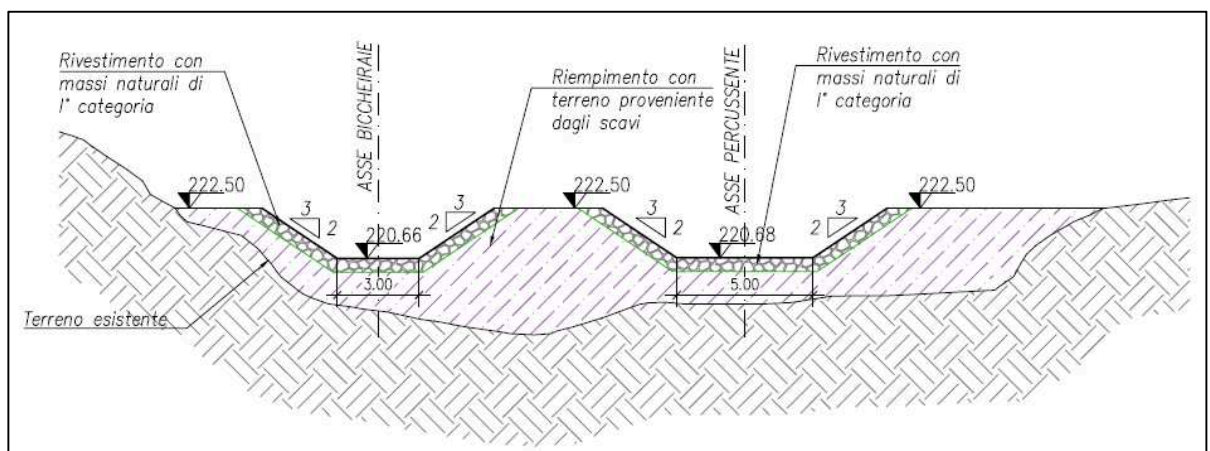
Sezioni tipo zona da risistemare a monte del canale
